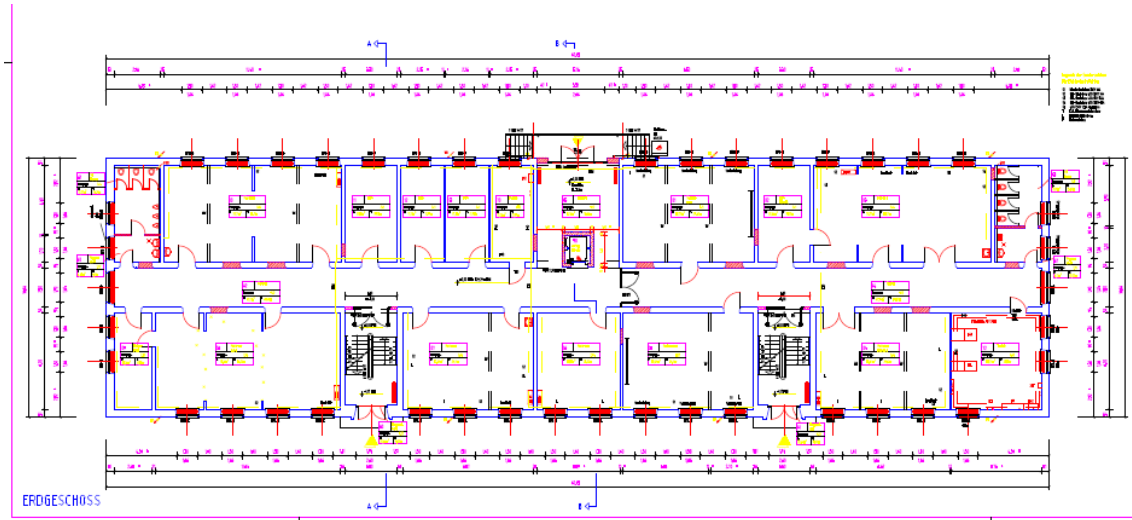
Grundrissplan EG, Gebäude FC
